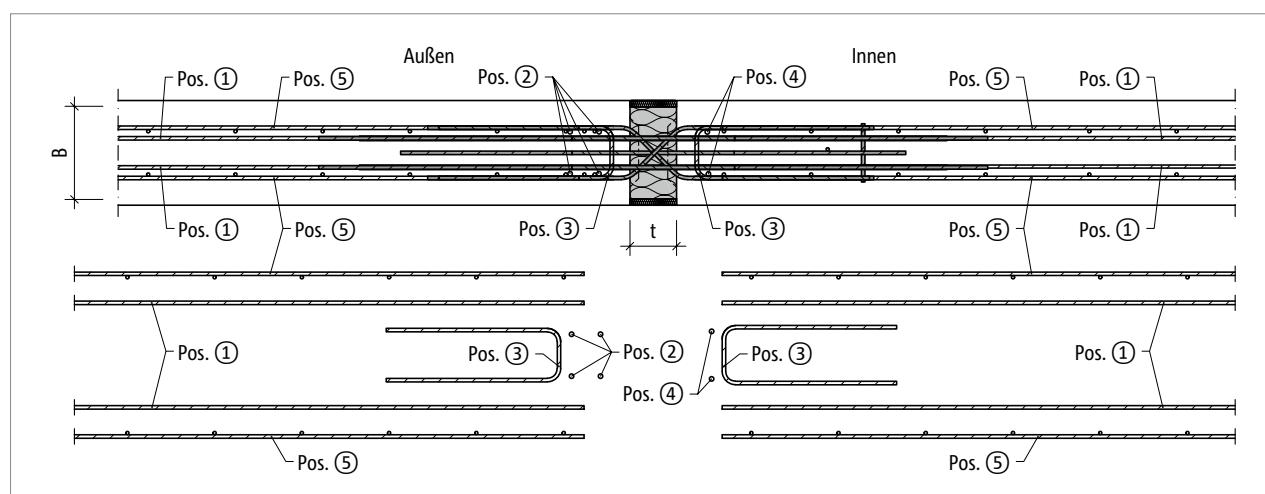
Schöck Isokorb® T Typ WL: Bauseitige Bewehrung; Grundriss
